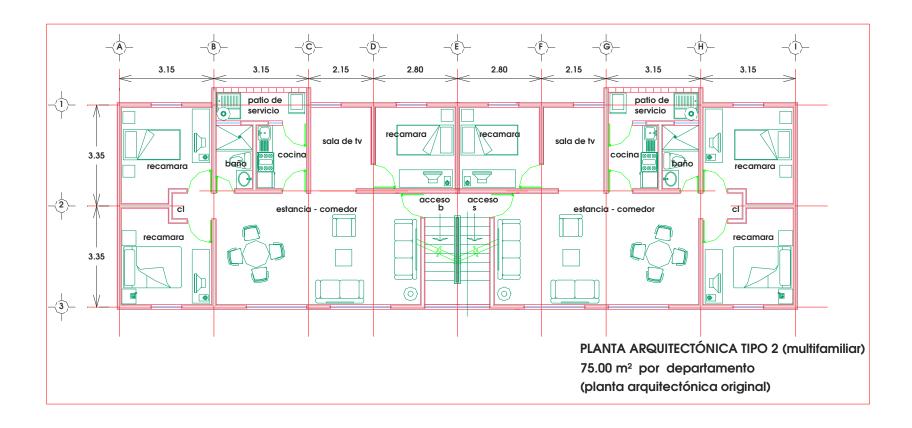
Planta arquitectónica multifamiliar tipo 2
